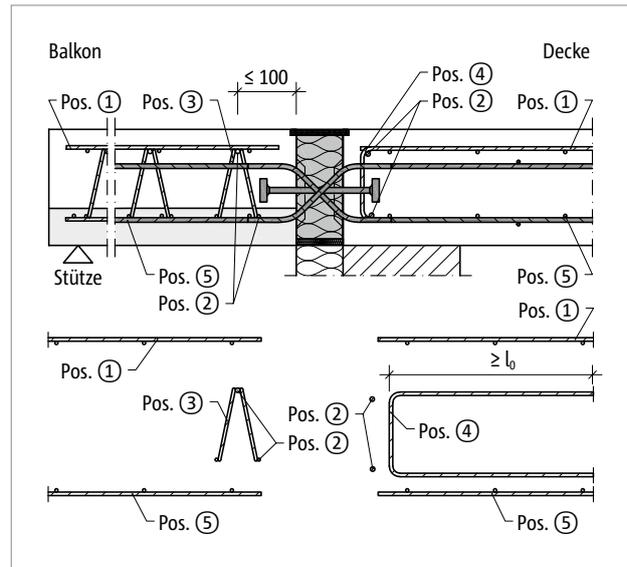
Schöck Isokorb® T Typ Q-P-VV: Bauseitige Bewehrung, balkonseitig mit Gitterträger
